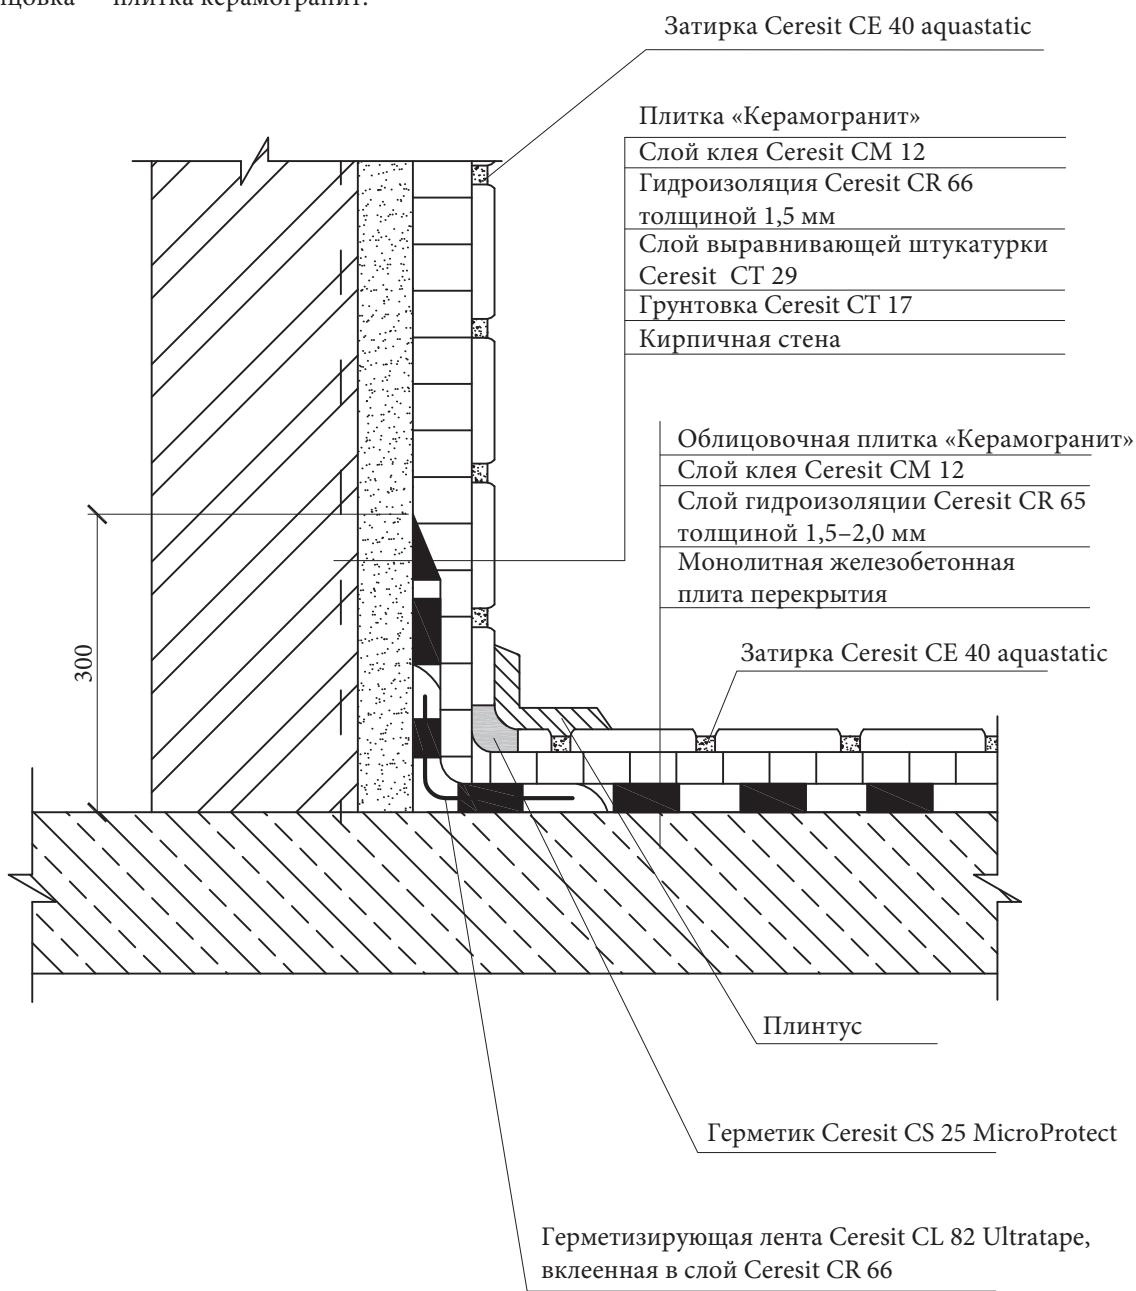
Конструкция системы гидроизоляции бытовых душевых, ванных комнат, санузлов, прачечных помещений, кухонь (стены выравнены полимерцементной штукатуркой)
